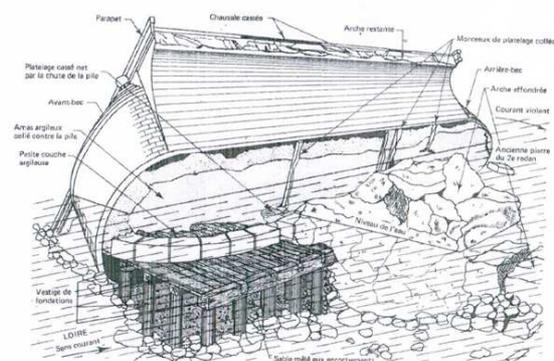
Vue en perspective des fondations de la pile 5 renversée le 10 avril 1978. Les pieux et le platelage délogés par les affouillements sont visibles sous le fil de l'eau.
